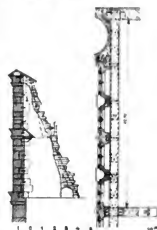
Grundriss und Schnitt. Massstab 1:300.
